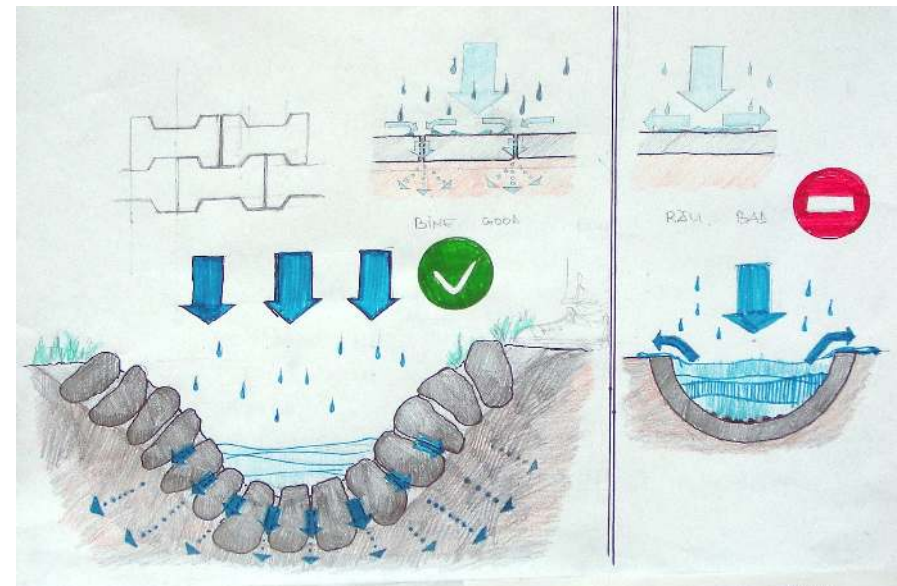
Propuneri pentru șanțurile colectoare de pe marginea drumului - varianta cu pietre de râu
